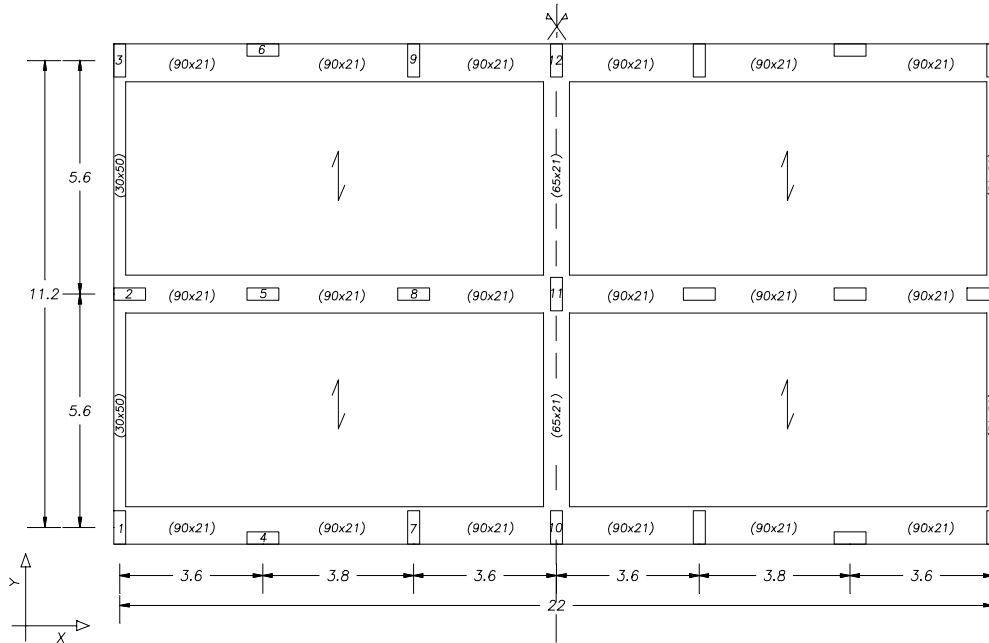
Edificio di otto piani: pianta piano tipo.
